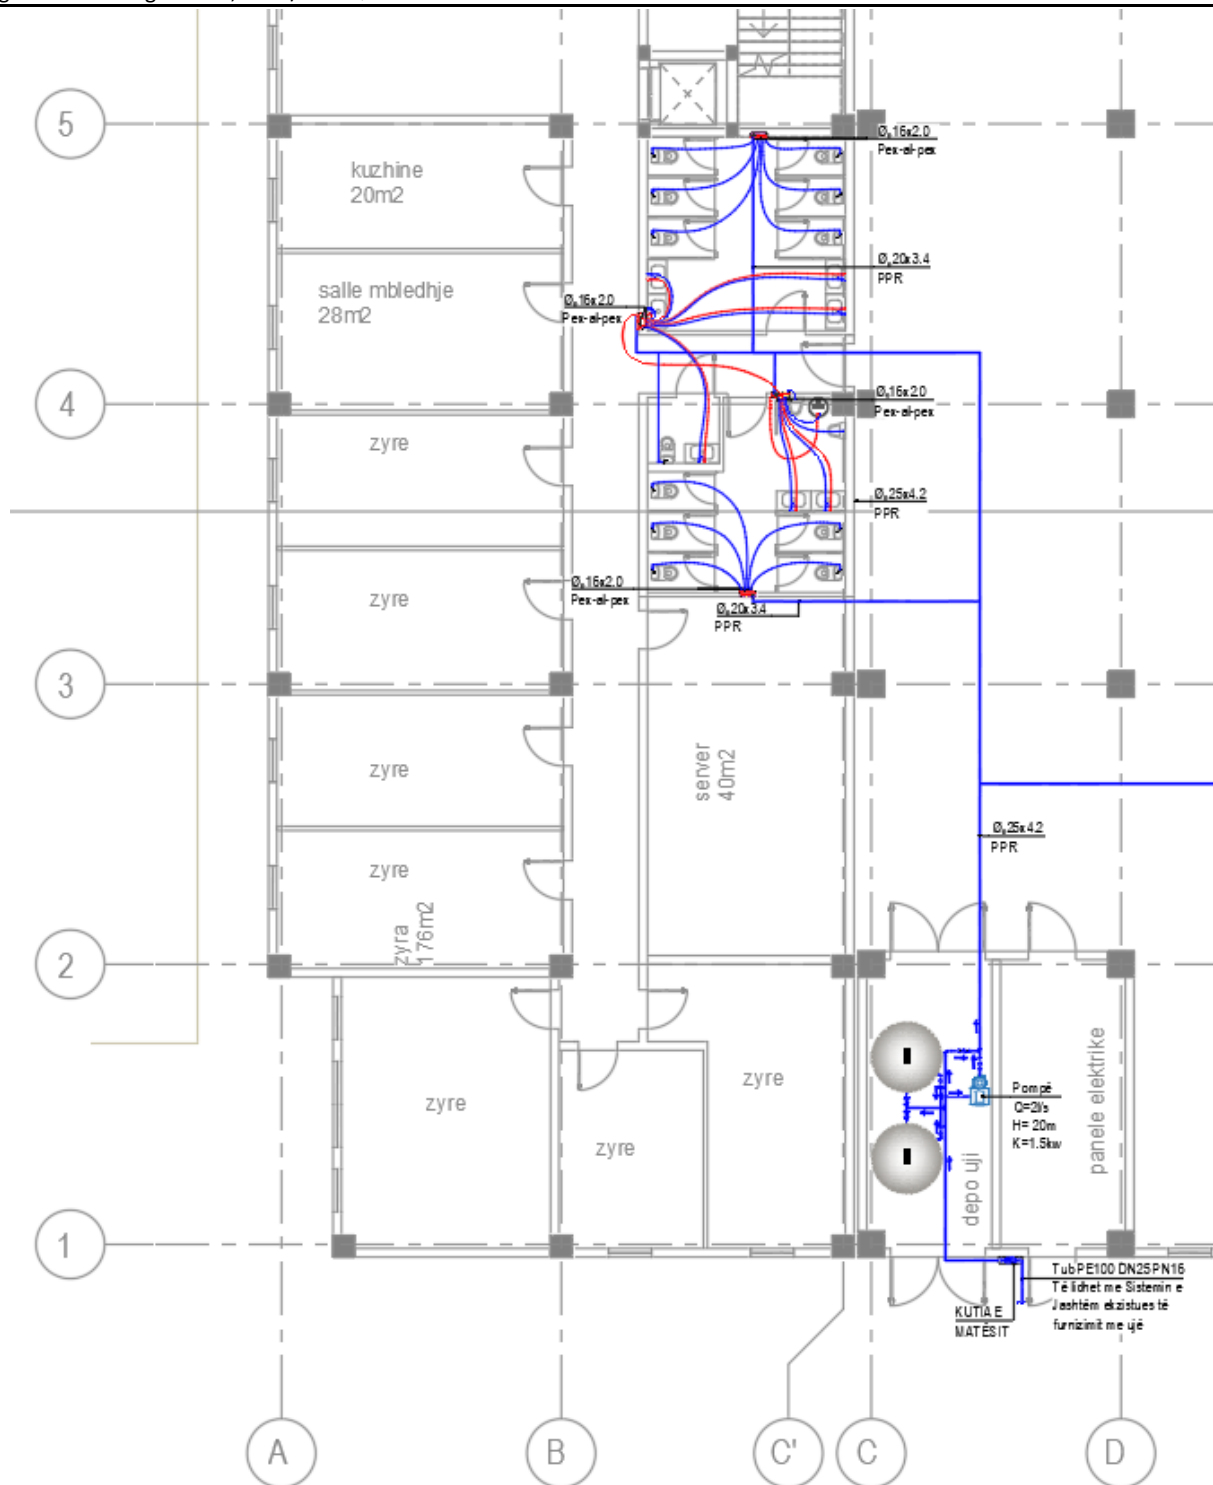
Planimetria e Nyjes Sanitare në ambientin e zyre
